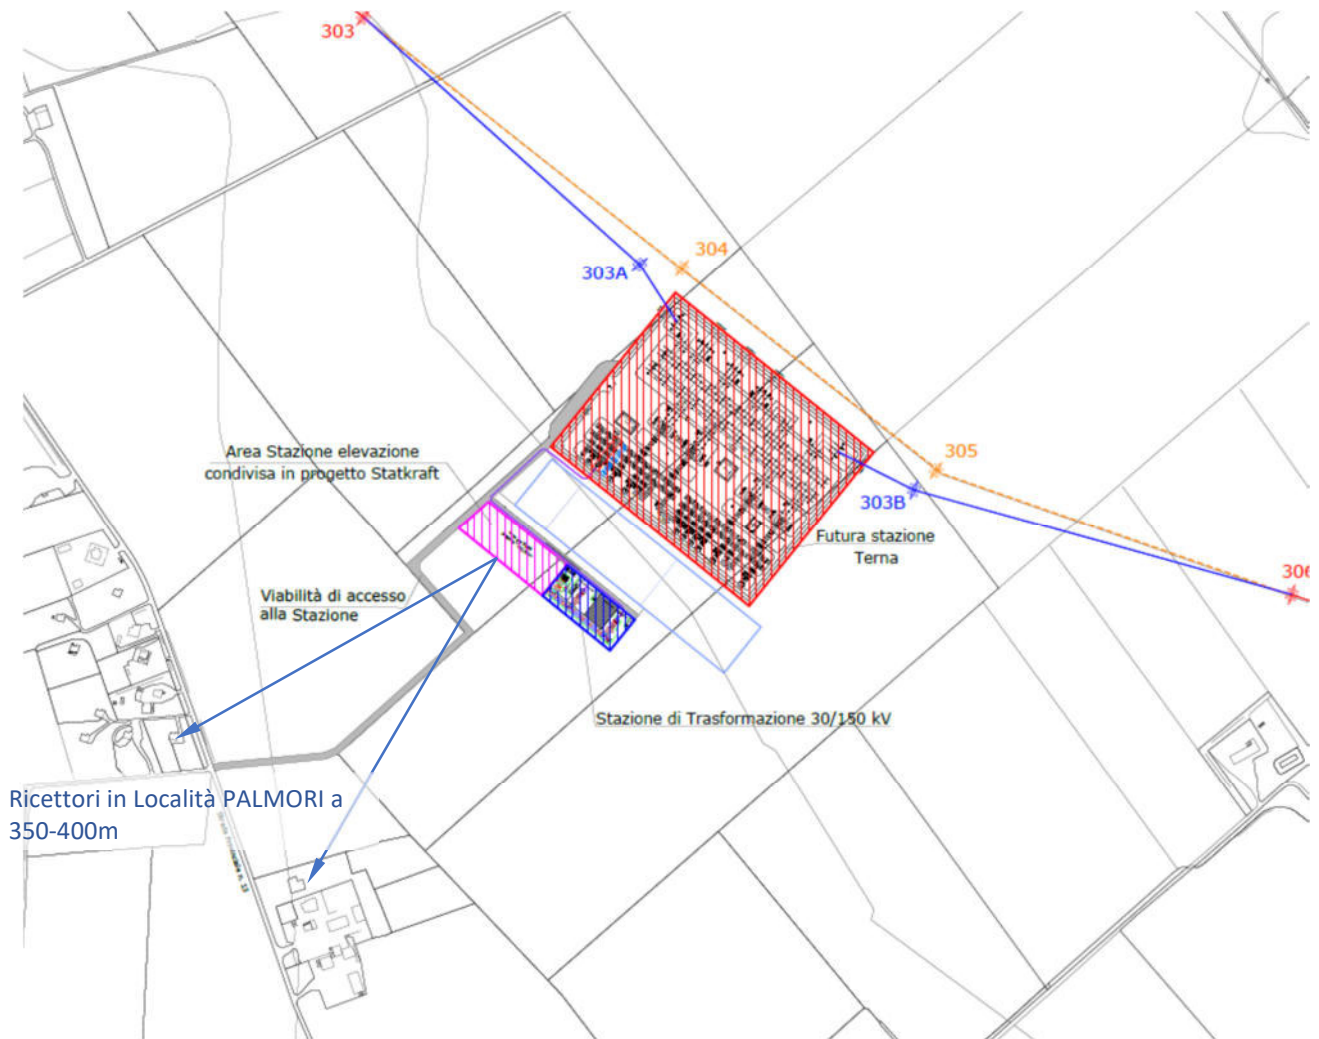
Layout della stazione condivisa con SSE di elevazione, trasformazione e storage del parco in progetto
